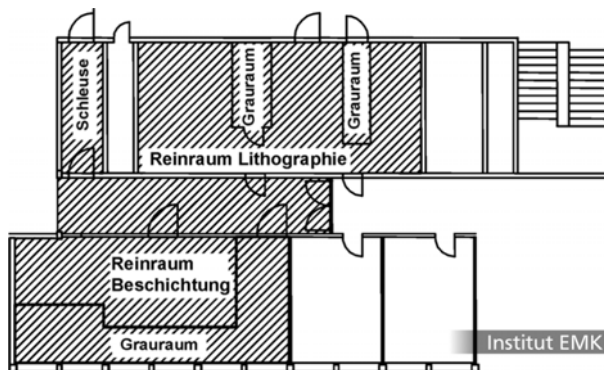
Reinraum-Labor für Mikrotechnik (Grundriss, schematisch)
